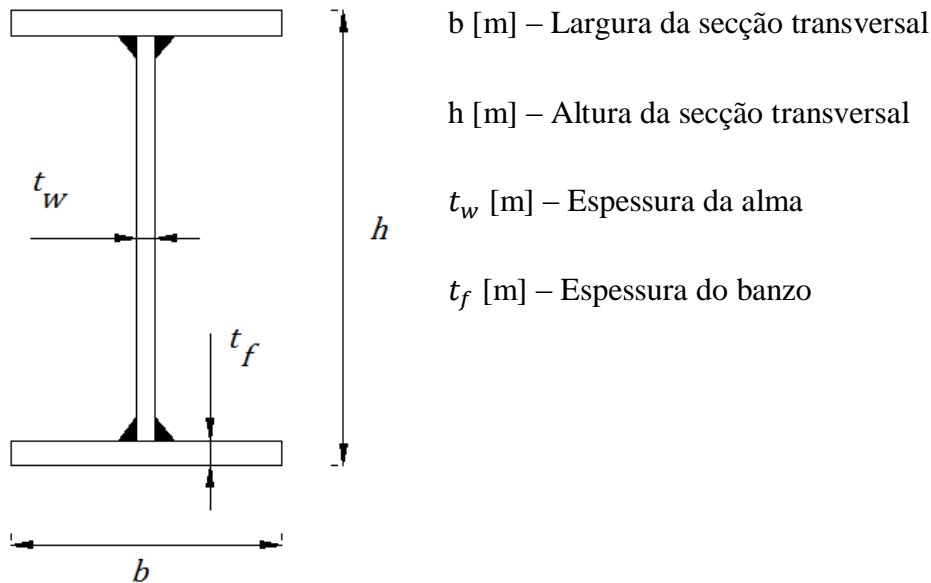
Características geométricas de um perfil metálico soldado.
